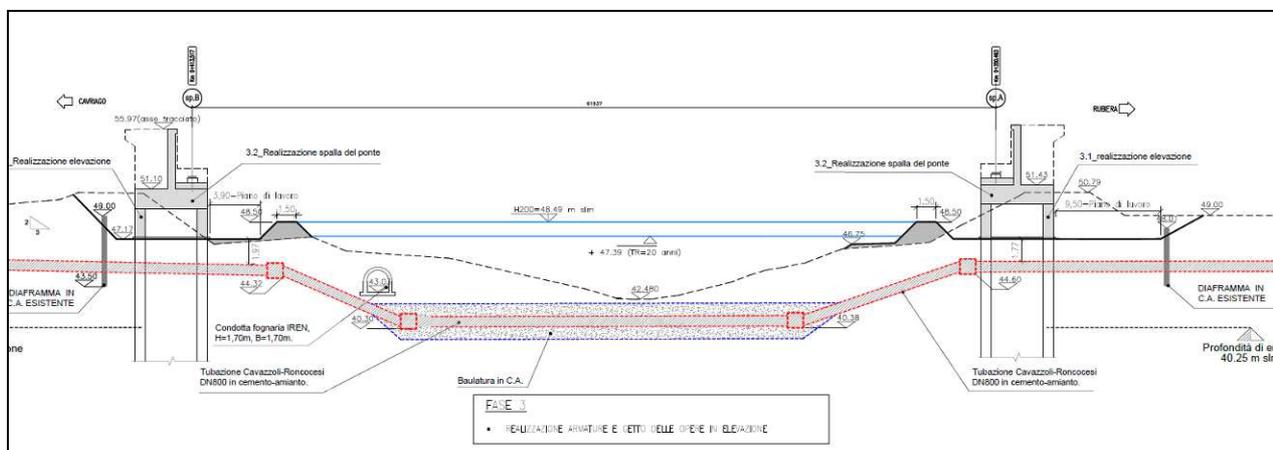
FASI ESECUTIVE DI CANTIERIZZAZIONE: REALIZZAZIONE DELLE FONDAZIONI E DELLE OPERE IN ELEVAZIONE.
